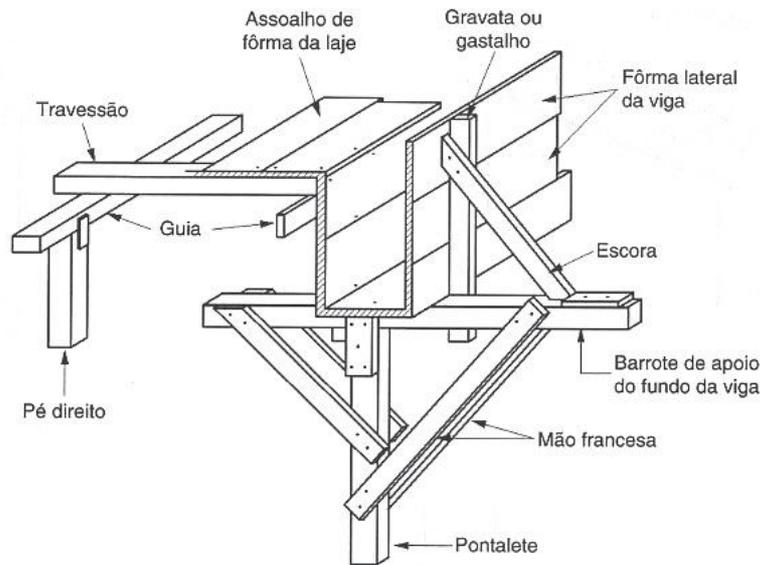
Sistema tradicional de fôrmas de madeira para vigas e lajes em concreto (ABCP, 1944).
